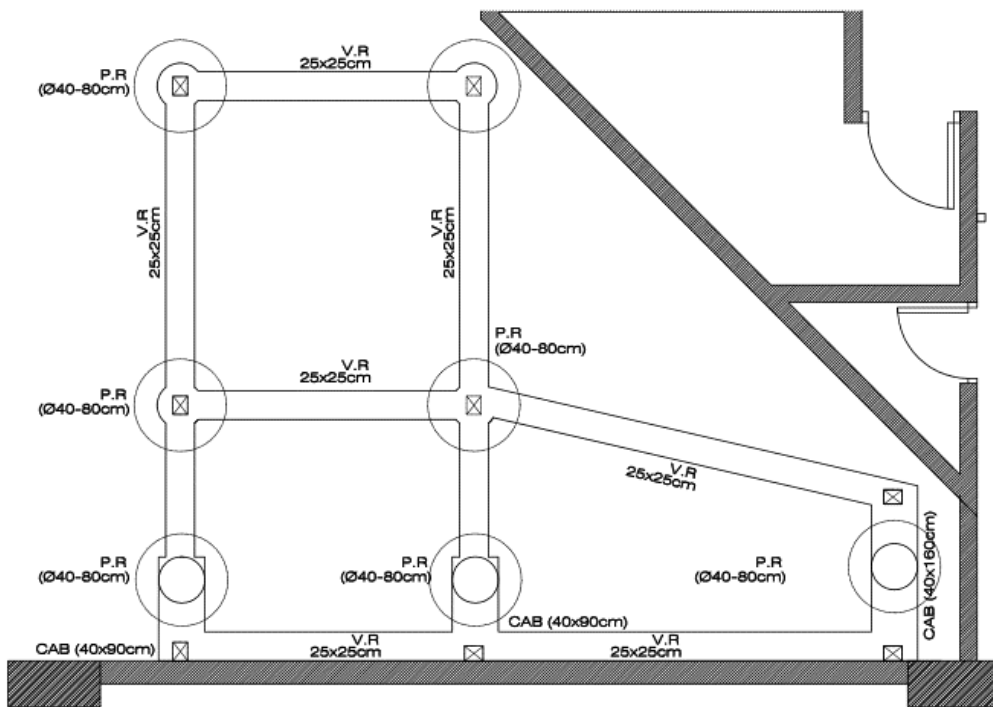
Planta de Fundación esc. metálica sobre Av. Haya de la Torre
